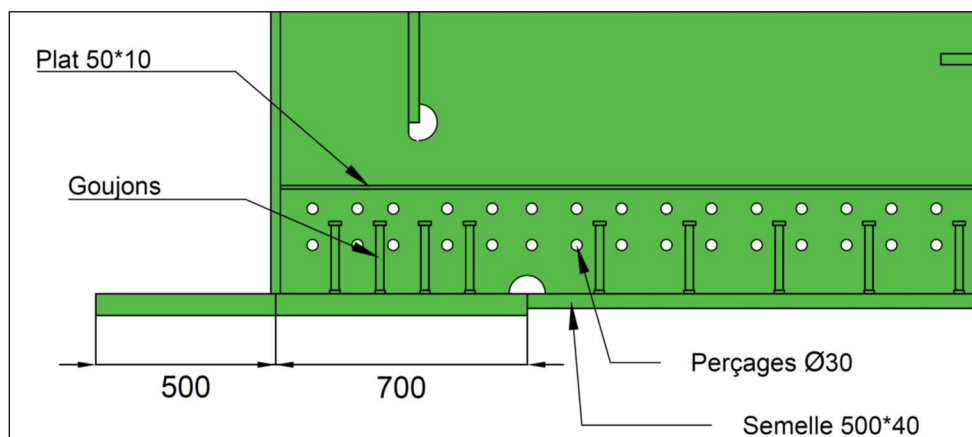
Détail des semelles inférieures d'une poutre principale et d'un diaphragme en zones DAM
